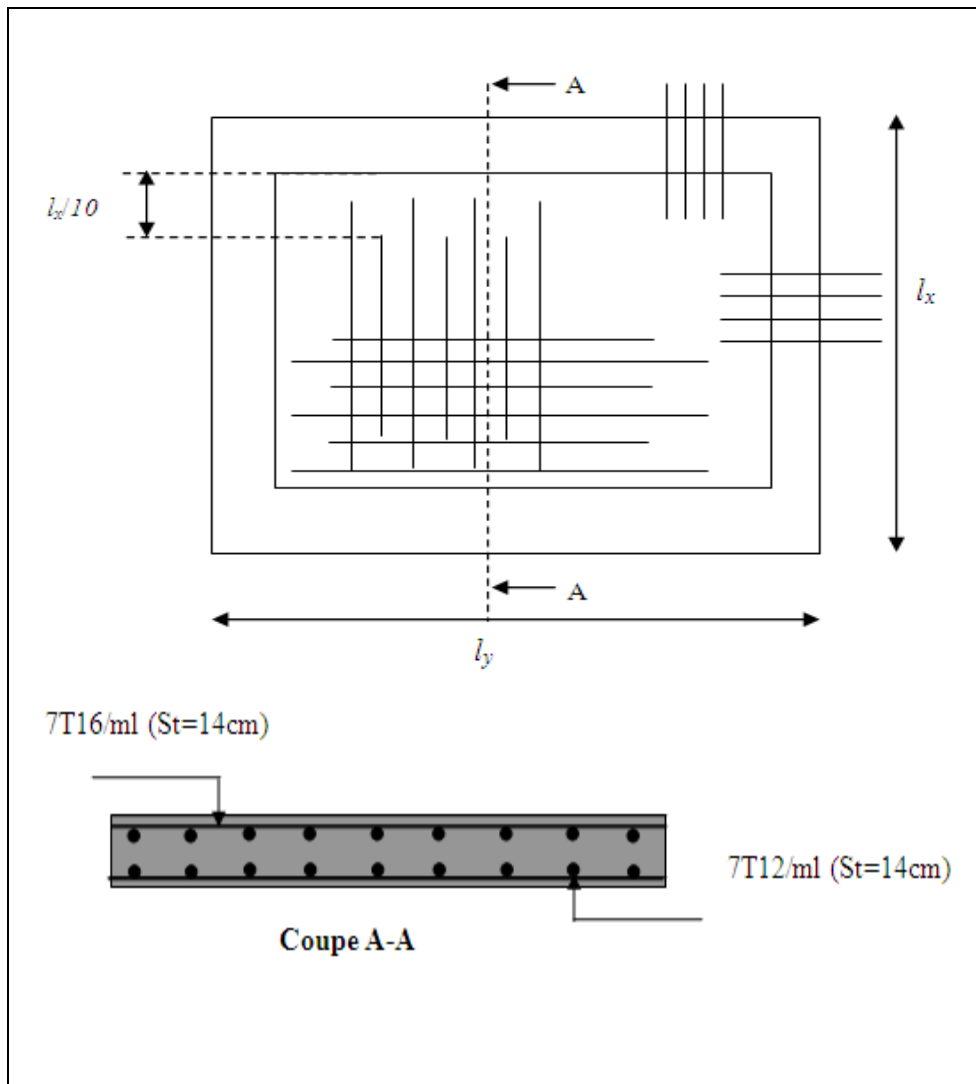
Schéma de Ferrailage de la dalle du radier
